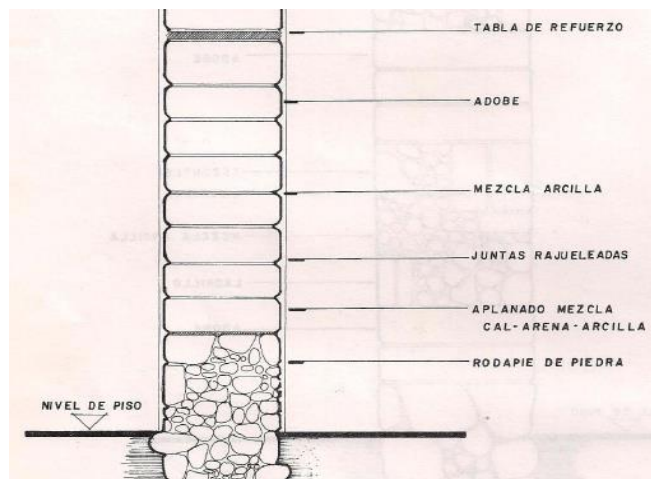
Detalle en mamposteo de piedra donde se aplica el aplanado de cal-arena.
